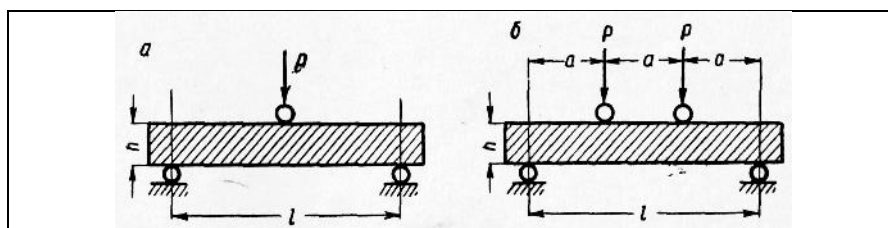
Схемы испытания строительных материалов на изгиб сосредоточенными грузами: а - одним; б - двумя.
